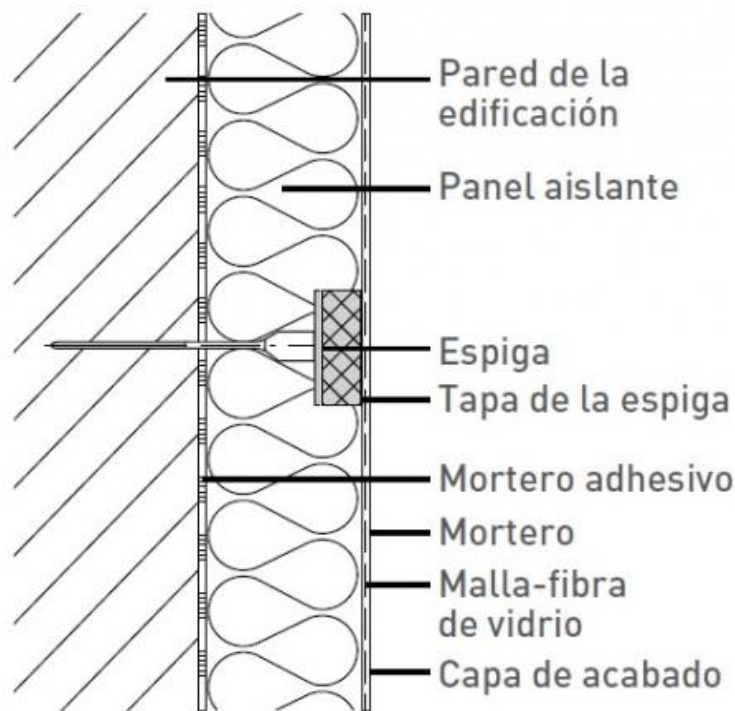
Sección constructiva del sistema SATE donde se observan las diferentes capas que lo componen y la instalación de las espigas de plástico. Fuente: ANFAPA, Morteros y Sate. Sistema de Aislamiento térmico por el exterior (SATE) <https://www.anfapa.com/es/sate/274/anclaje>.
